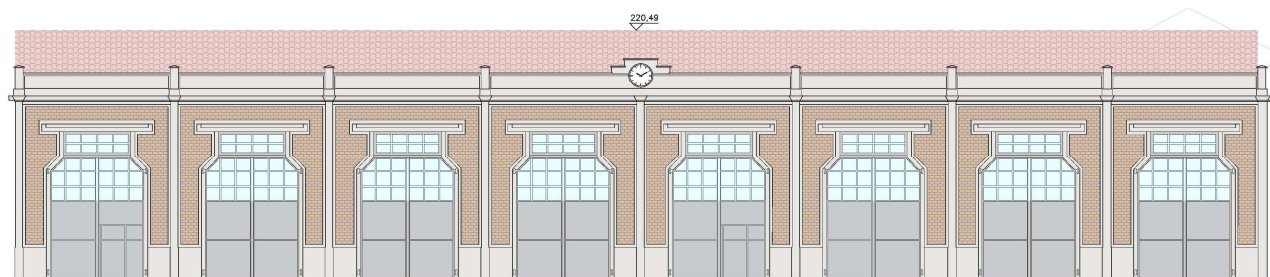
Edificio 4 Prospetto Sud - Ovest
